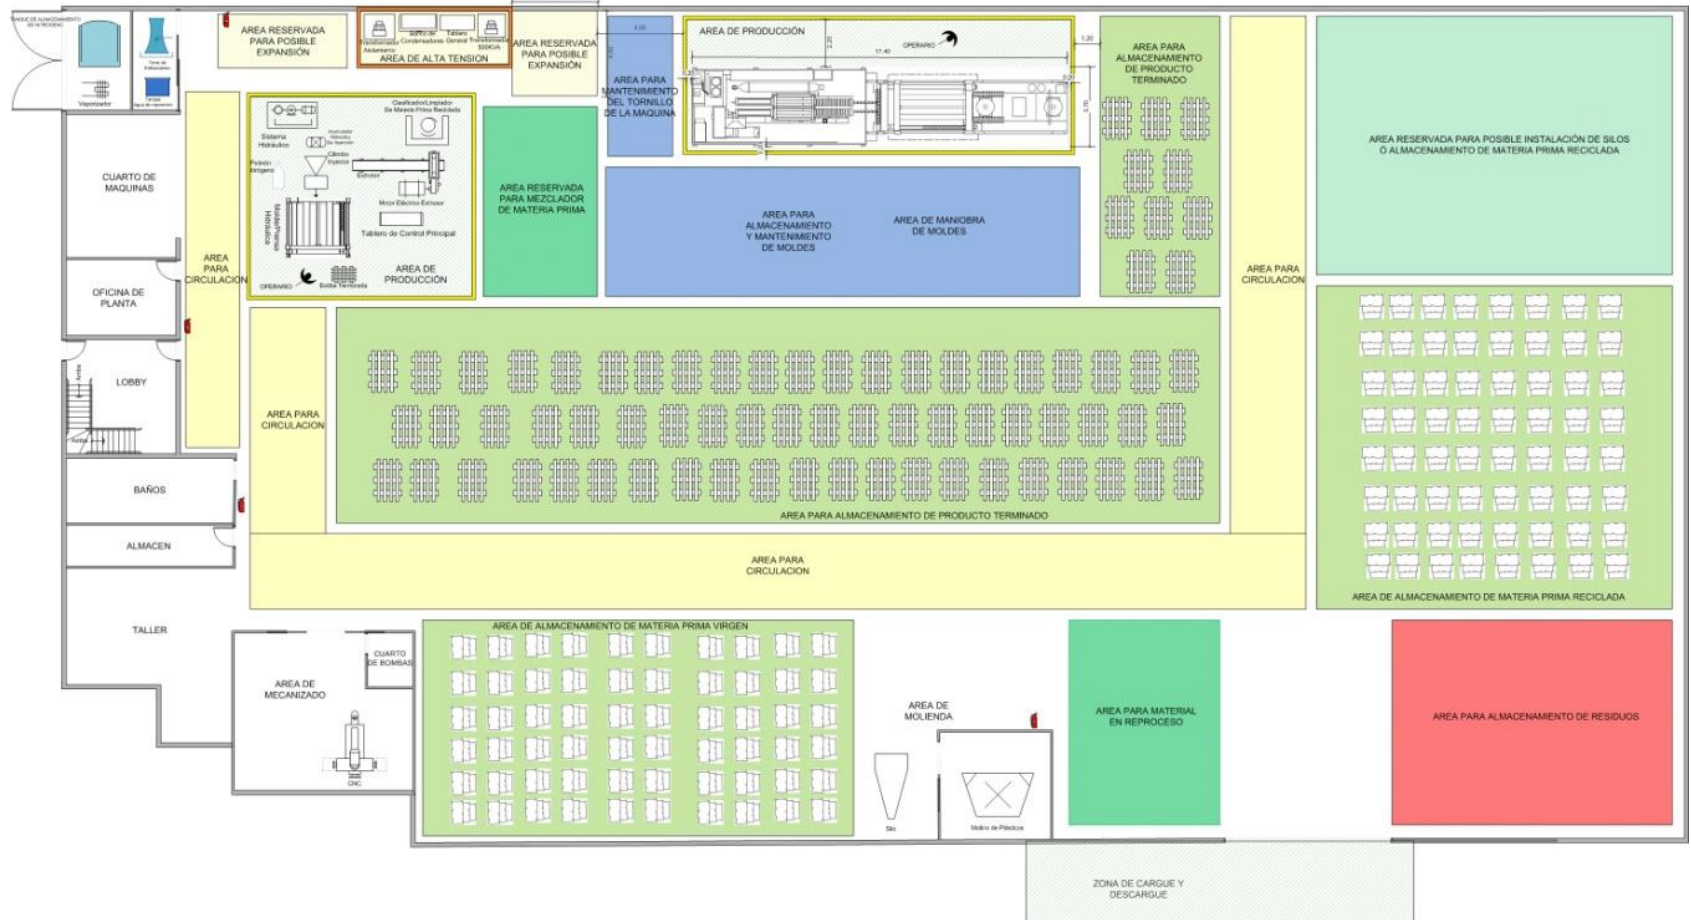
Distribución de planta y ubicación de la máquina – Opción B
